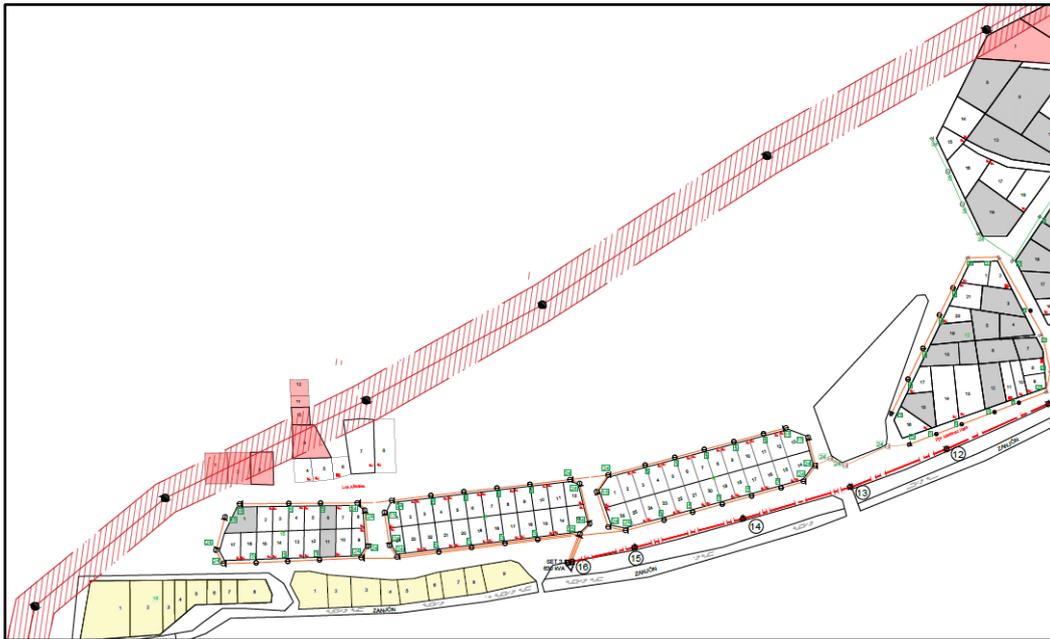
Planimetría de la red de BT en la zona de la SET 3.
